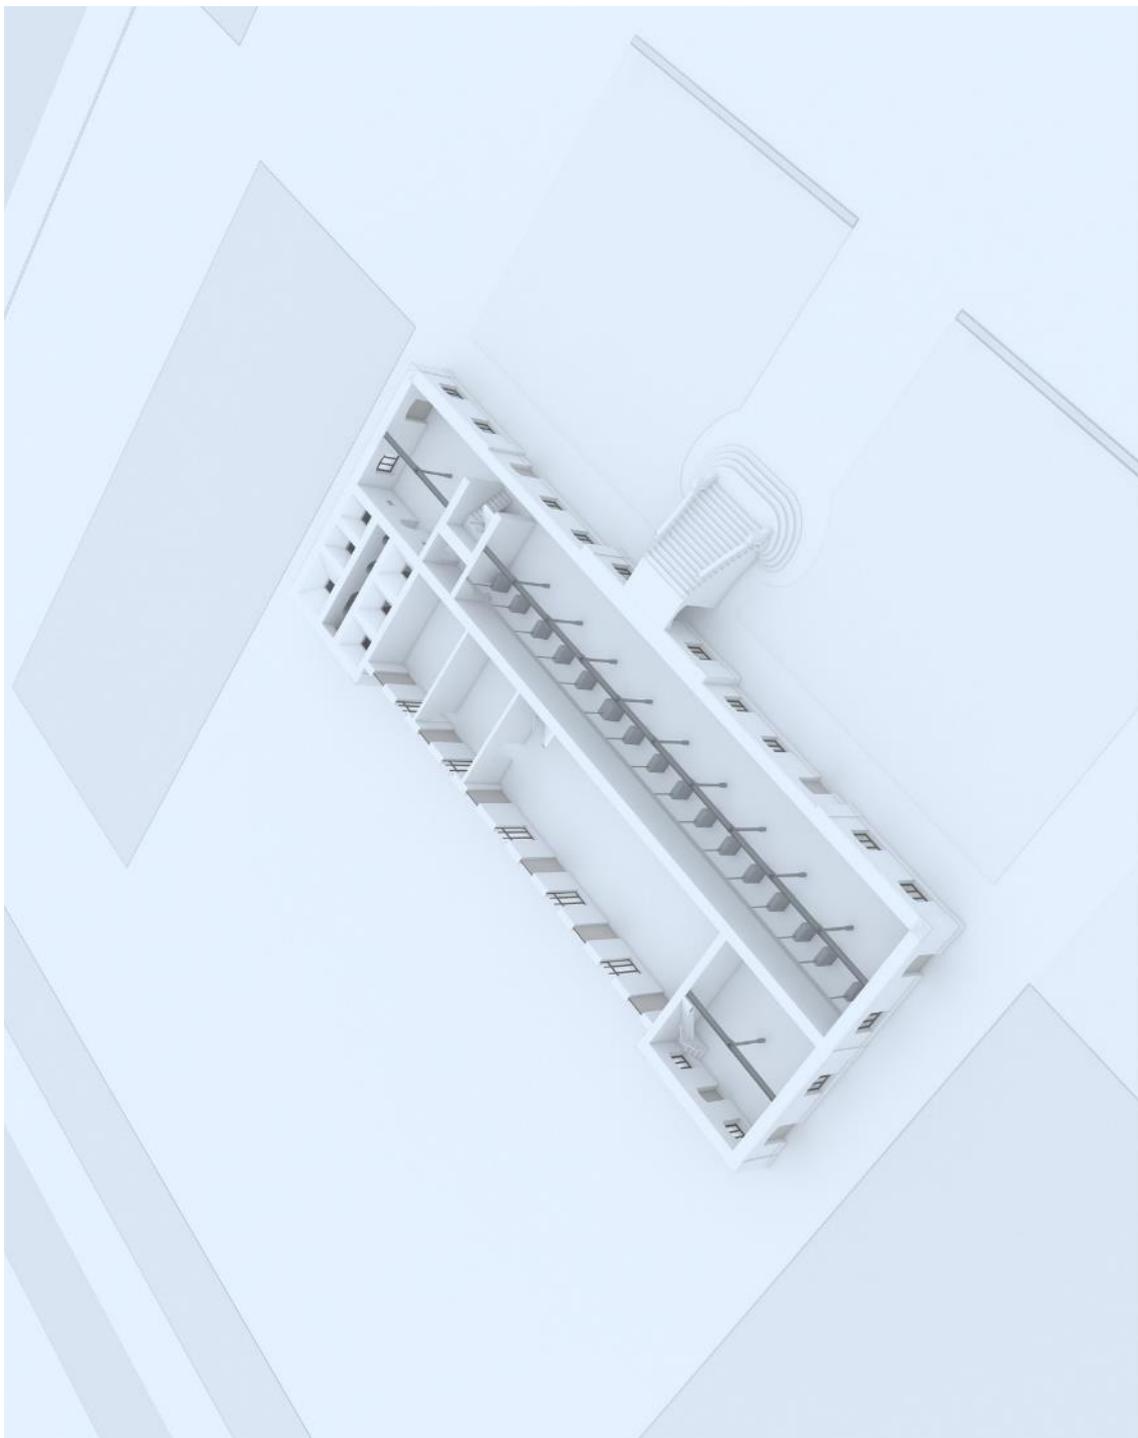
Imagen virtual. La fábrica. Planta baja. Sección por debajo de las viguetas de forjado.
